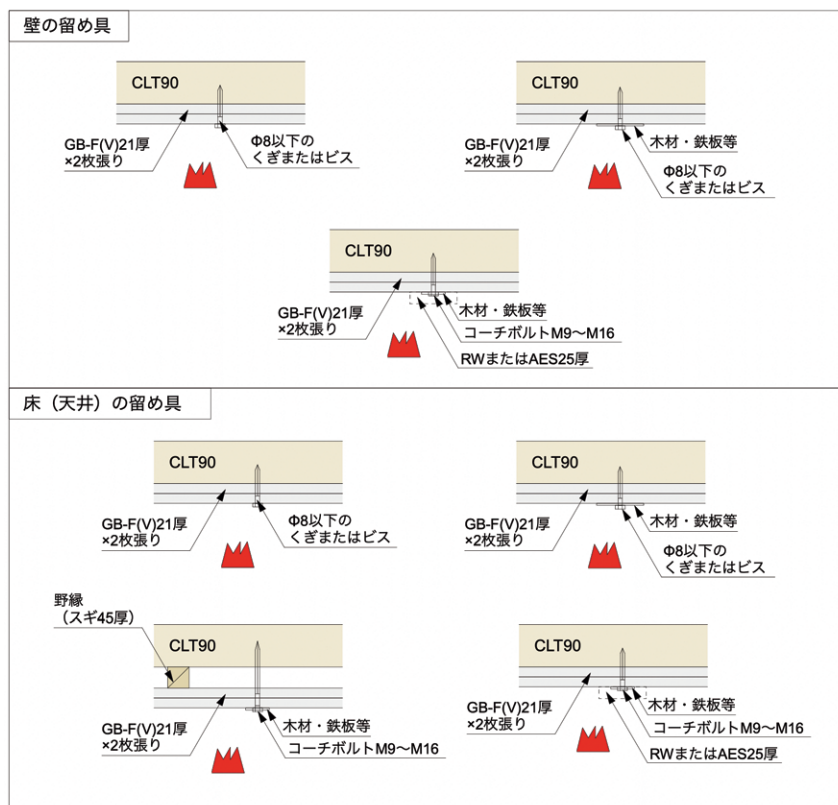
1時間耐火構造壁・床の留め具の納まり案 (単位: mm)
